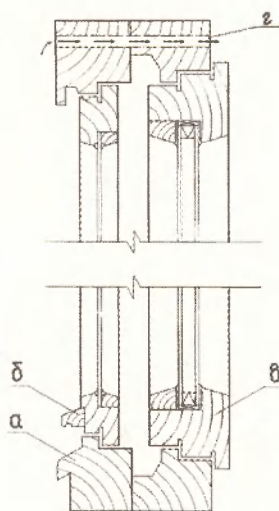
Окно с трехслойным остеклением в деревянных раздельно-спаренных переплетах: а – оконная коробка; б – переплет с одинарным остеклением; в – переплет с однокамерным стеклопакетом; г – приточное вентиляционное отверстие
